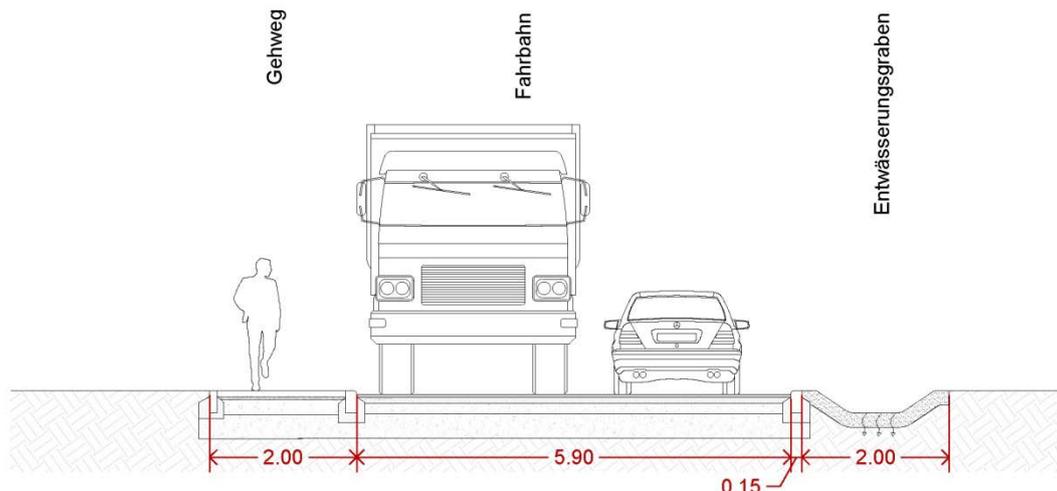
Querschnittgestaltung Zufahrtsstraße zur B6 (Planstraße A)
